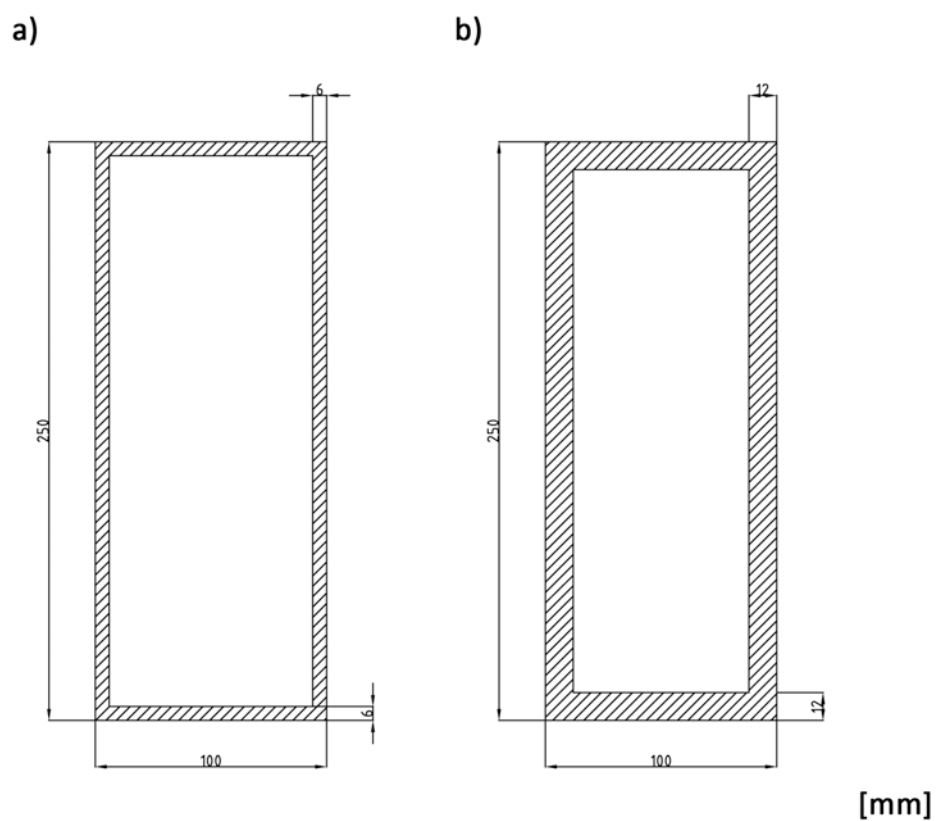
Secção transversal das vigas a) longitudinal e b) transversal
